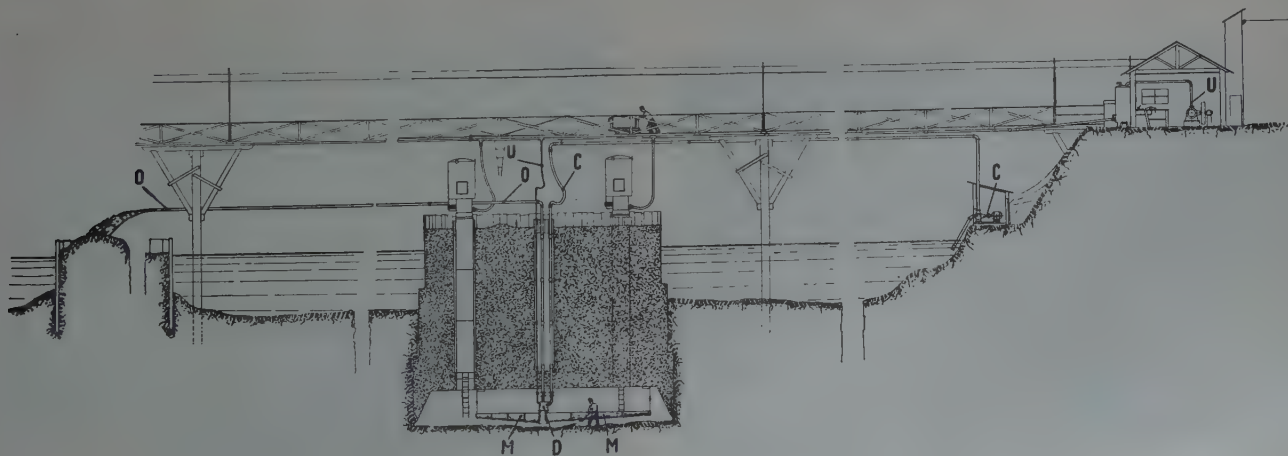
Schéma général d'installation de la pompe dans un caisson.
